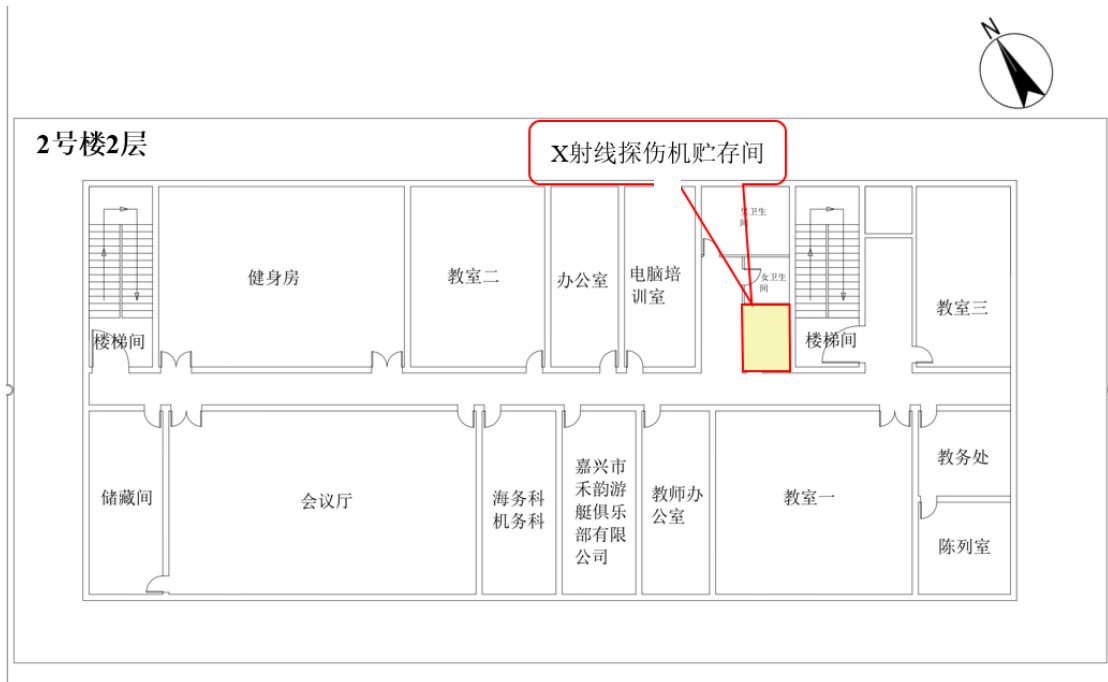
厂区 2 号楼 2 层平面布置示意图 (X 射线探伤机贮存间位置)
